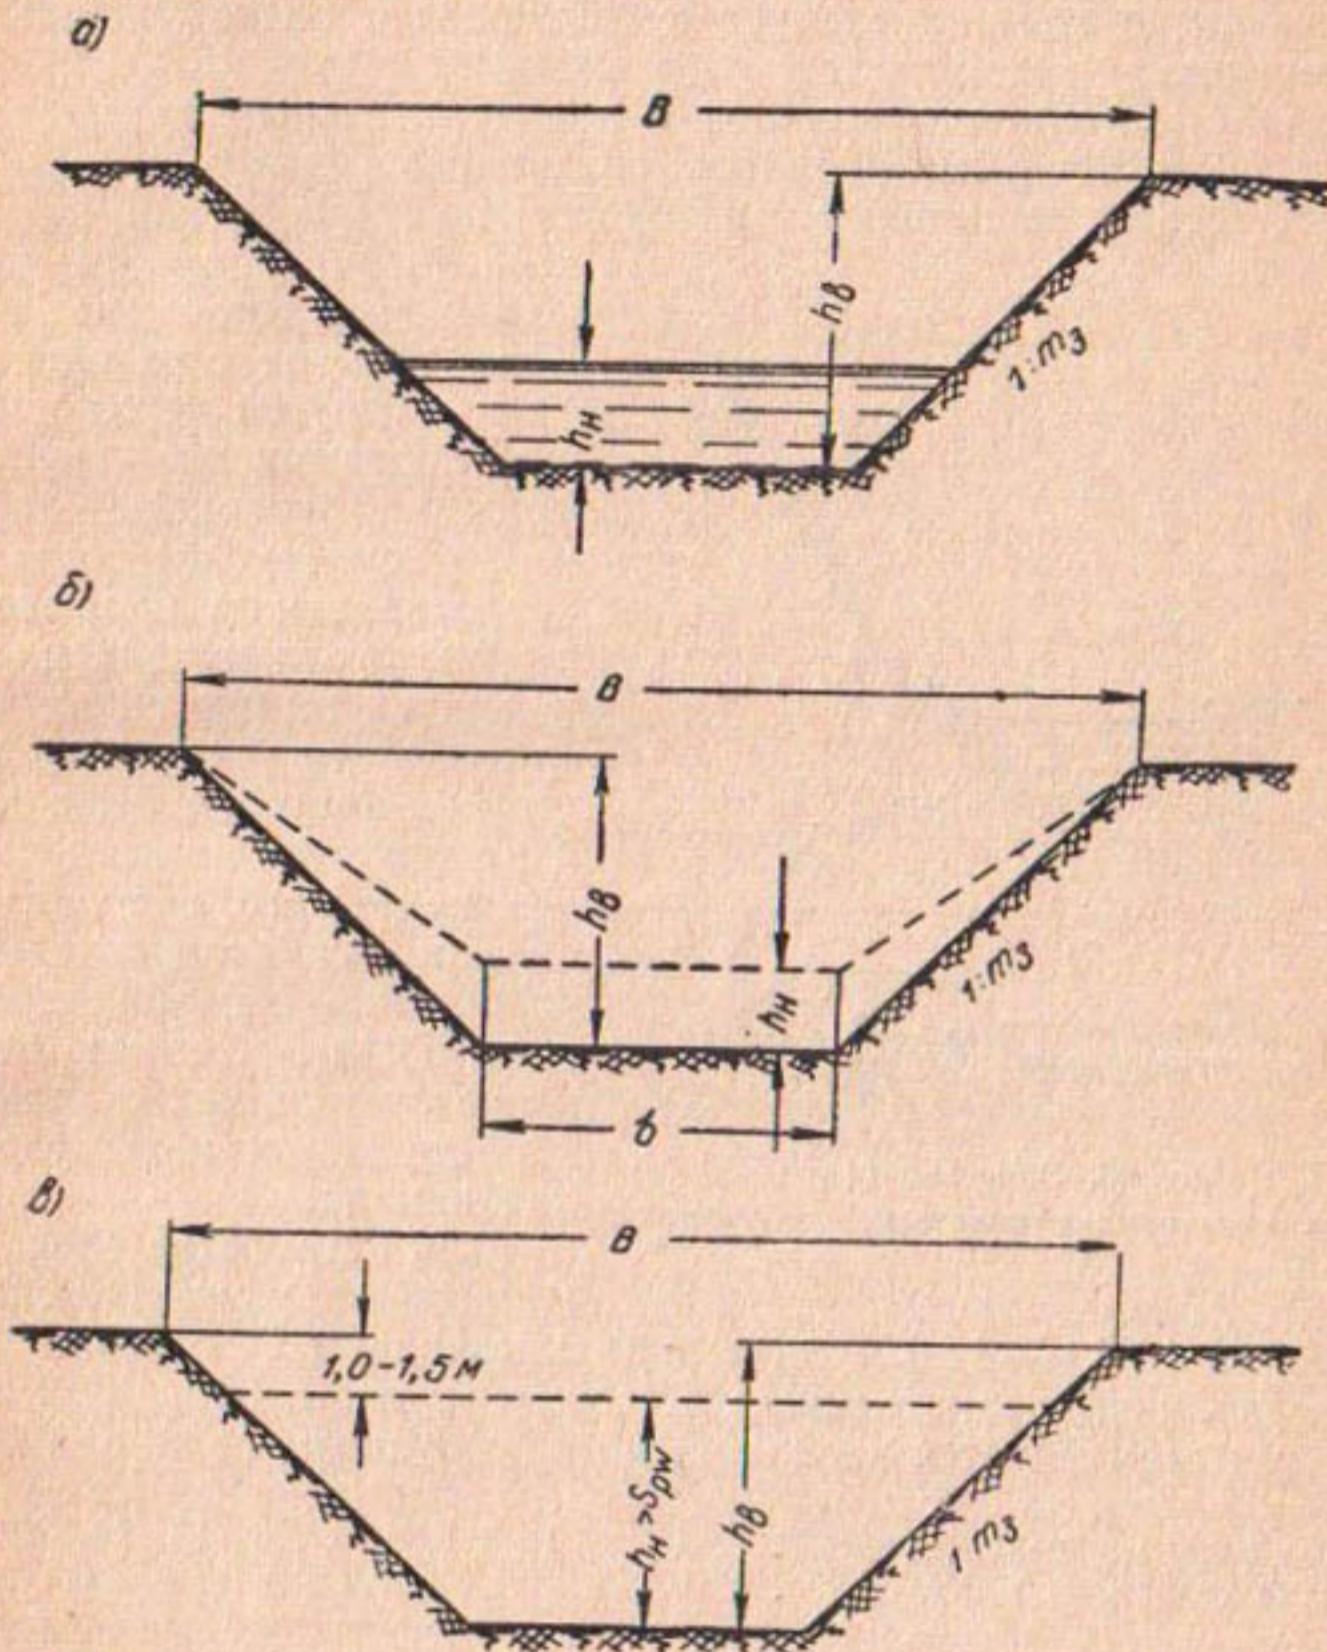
Поперечные сечения каналов с недобором грунта:
